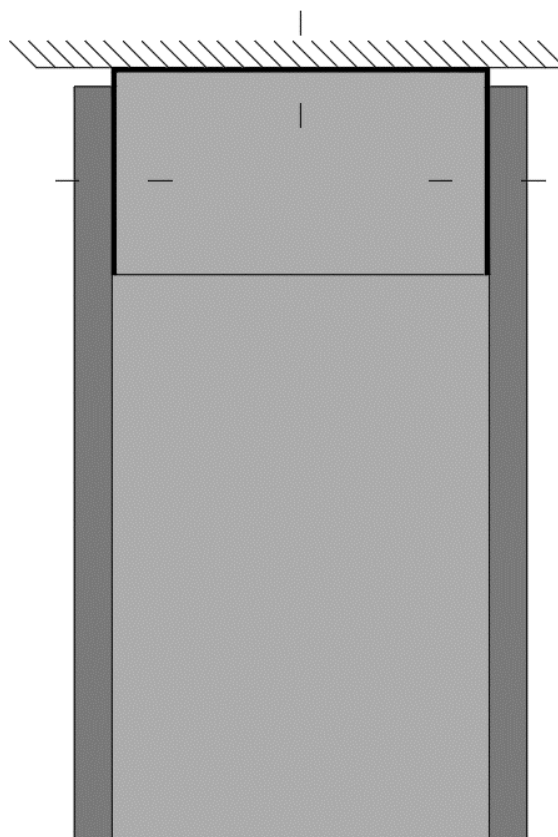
Corte transversal da ligação do painel sandwich ao topo.
